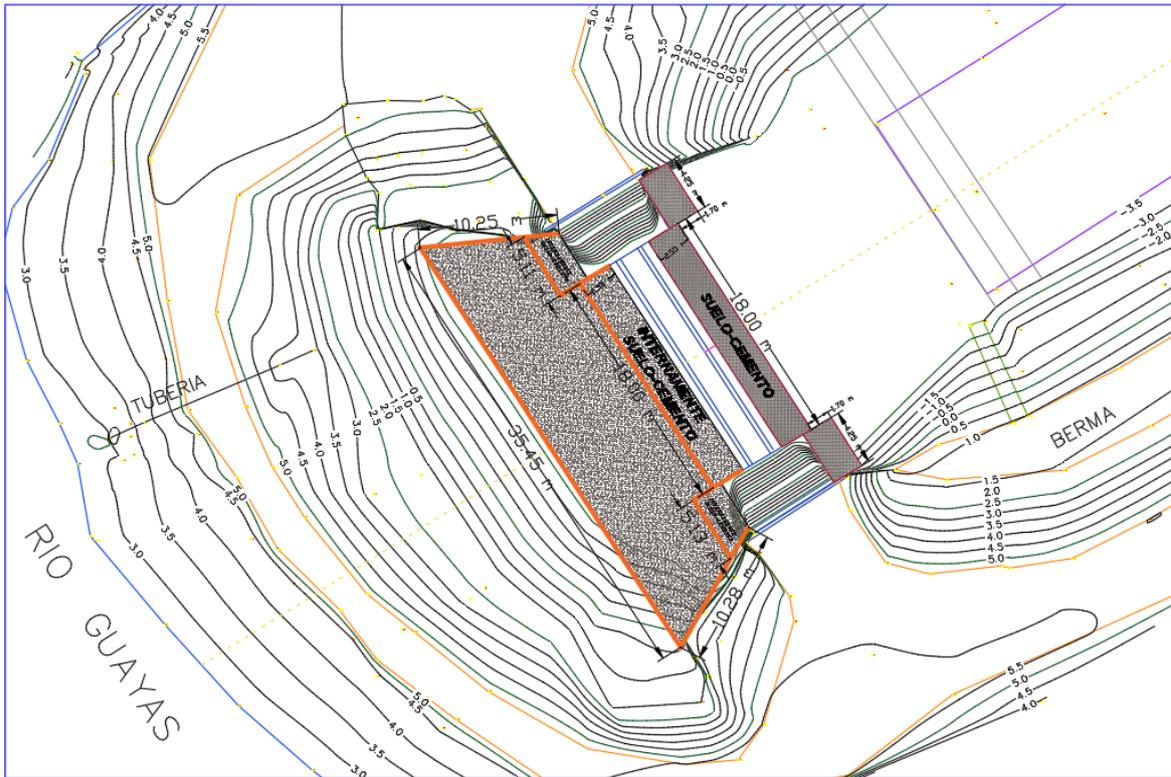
Vista en planta de la pantalla de tablestacas y la solución de suelo cemento en torno a la estructura de cimentación de la compuerta.
